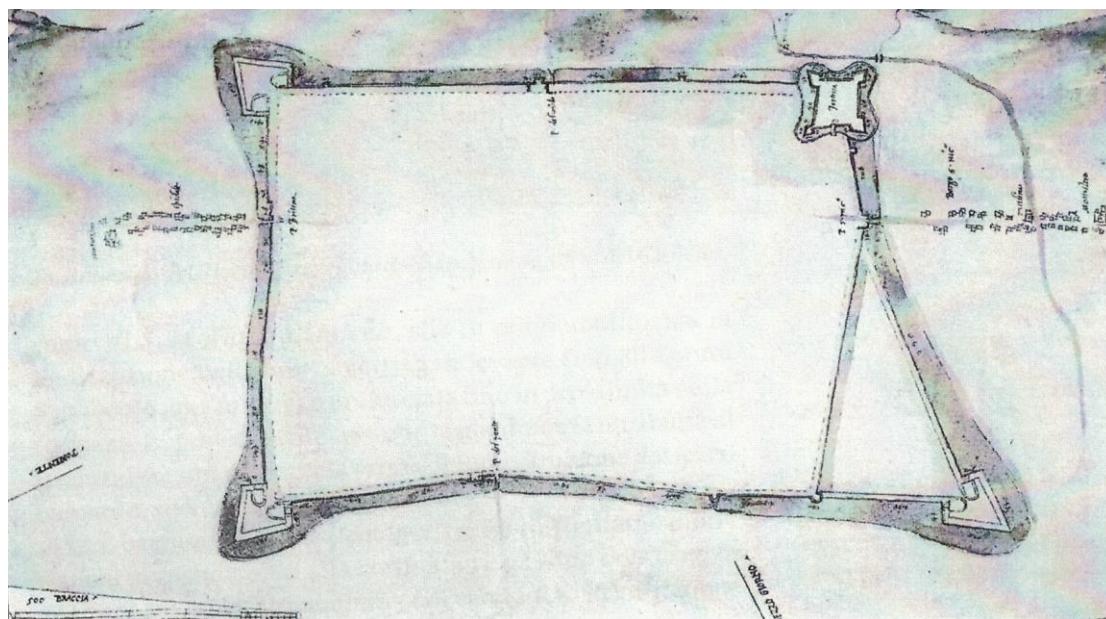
Planimetria cinta muraria di Sansepolcro e dei borghetti di S. Lorenzo e S. Niccolò, attribuita al Belluzzi, 1546 - 1547
